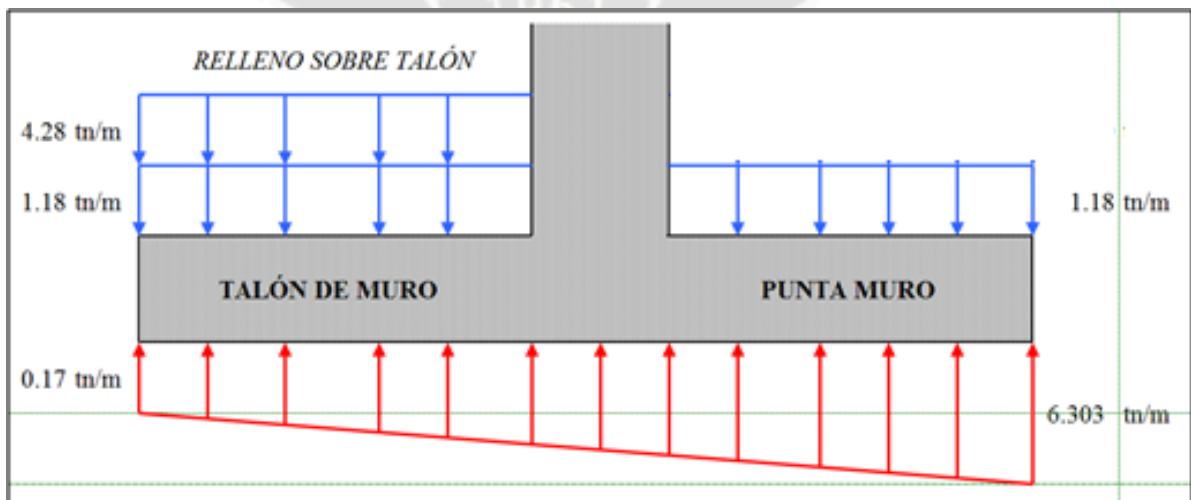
Esquema de presiones actuantes sobre y debajo de la cimentación del muro.
